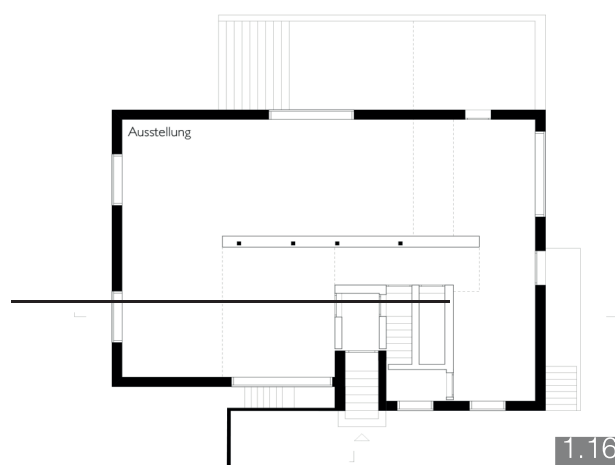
Dibujo de la planta baja de la Casa Gropius.
